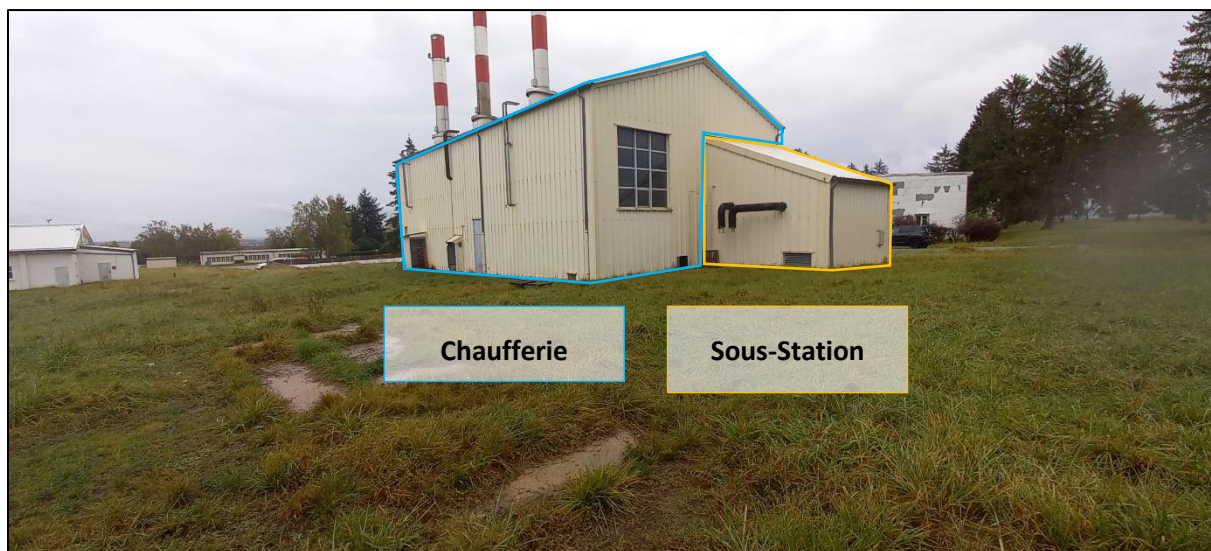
Façade ouest et sud du bâtiment 0124 - Chauffage.
